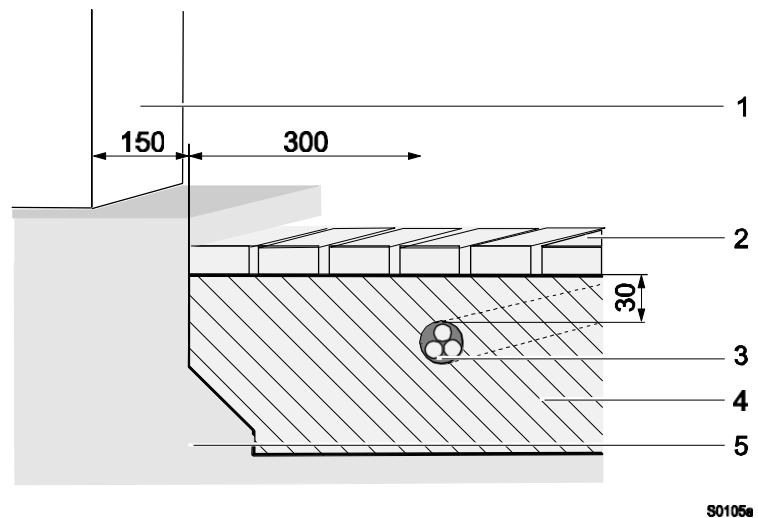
Coloque el lazo inductivo en el pavimento compuesto (dimensiones en mm)
